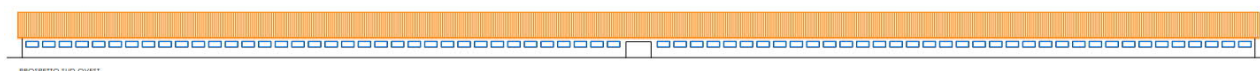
Prospetto Sud/Ovest porcilaia gestazione (estratto tavola 5)
